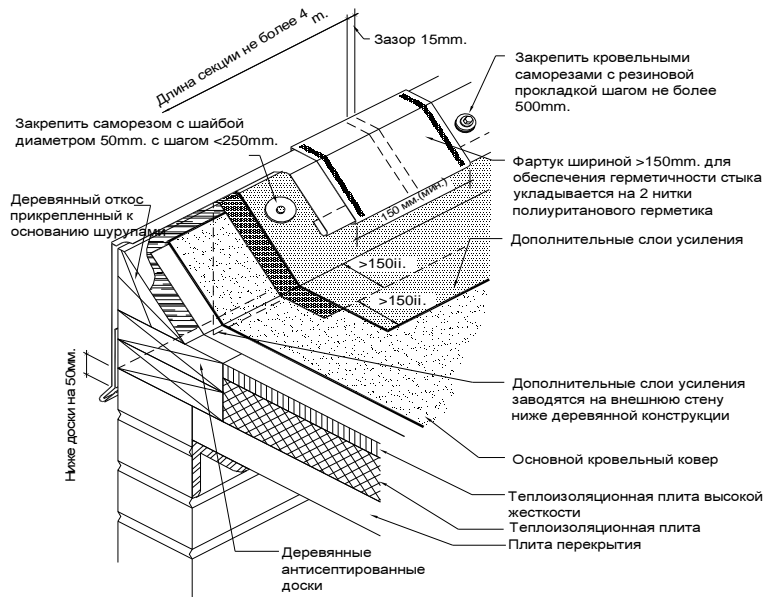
Устройство кровельного окончания для кровель без парапета.
